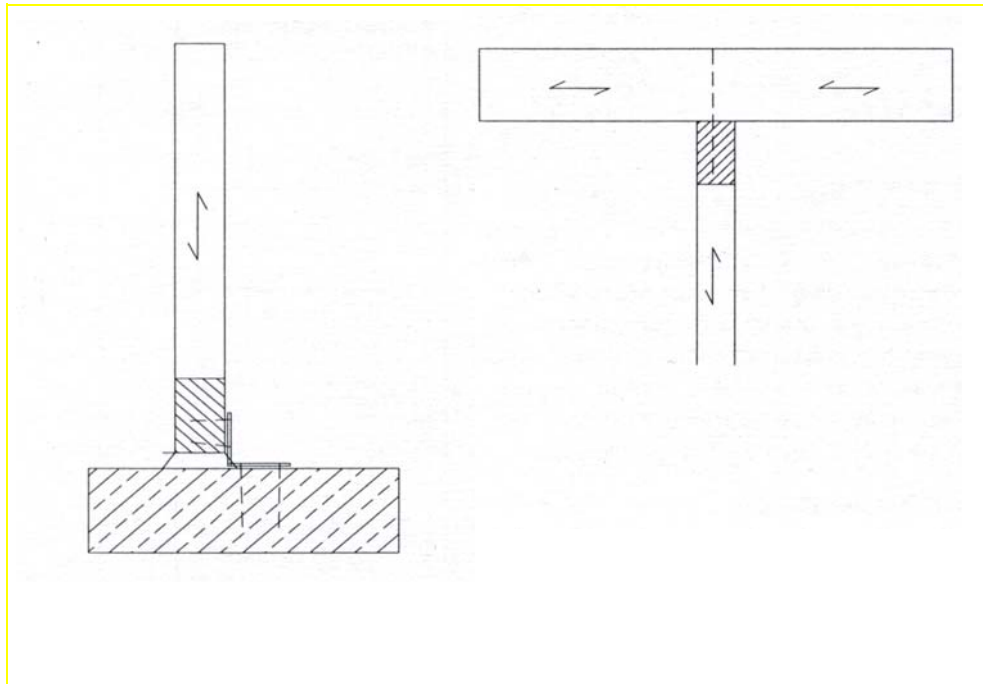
Konstruktionsdetails (hiwo, 2001)
